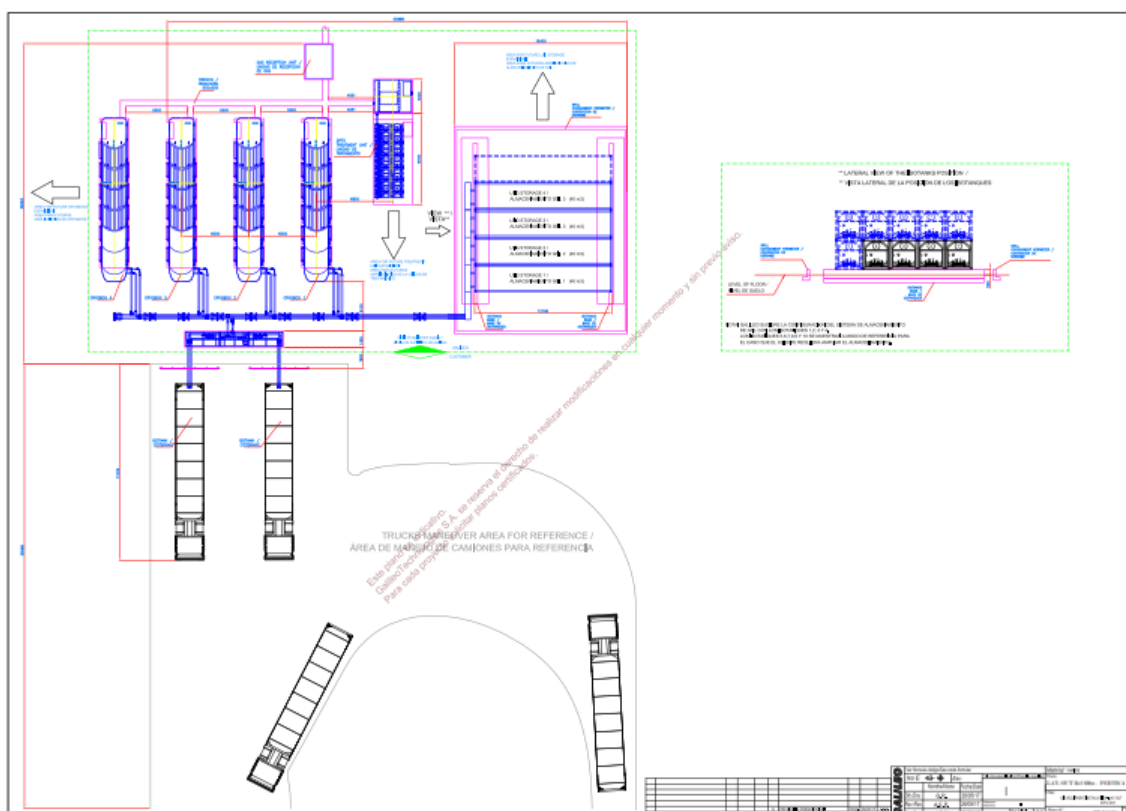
Lay Out de Planta de licuefacción Sistema Modular Cryobox + Planta de acondicionamiento de Gas+ Iso Tanques
